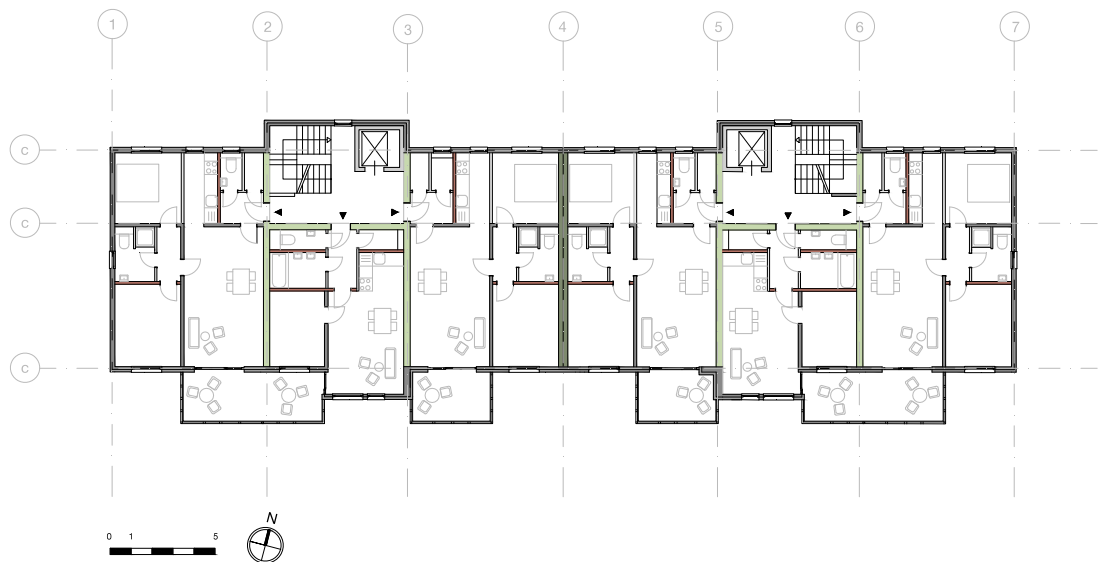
Grundriss Hofhaus Urbaneum Klagenfurt
